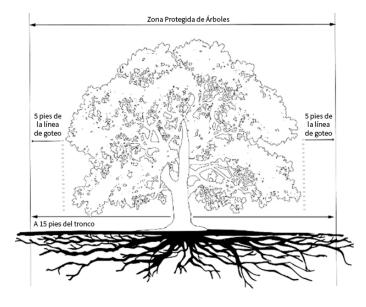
ZONA PROTEGIDA (VISTA EN ALZADO)
